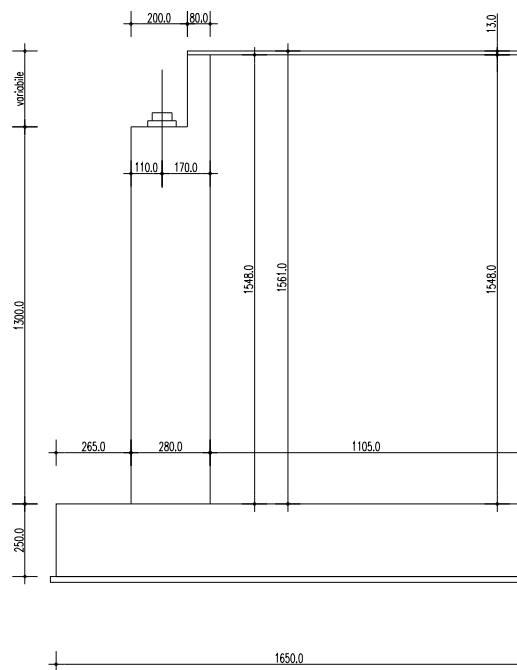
Vista laterale Spalla B 4.
